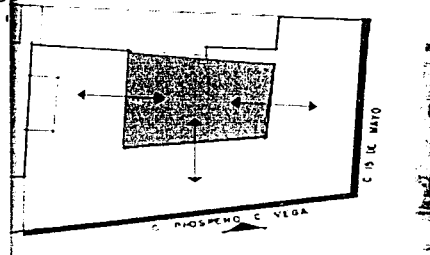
IMAGEN: Planta de conjunto de Próspero C. Vega No.33
